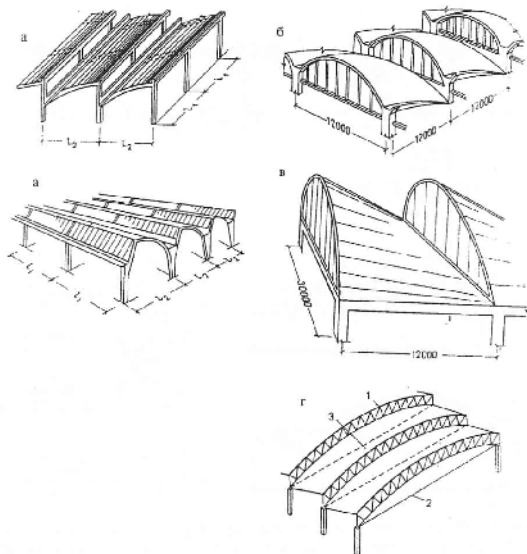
Пространственные тонкостенные конструкции шедовых покрытий: а – цилиндрические оболочки; б – покрытие с диафрагмами в виде железобетонных арок; в – коноидальная оболочка; г – покрытие с диафрагмами в виде стальных ферм: 1 – арочная ферма; 2 – натяжка; 3 – оболочка
